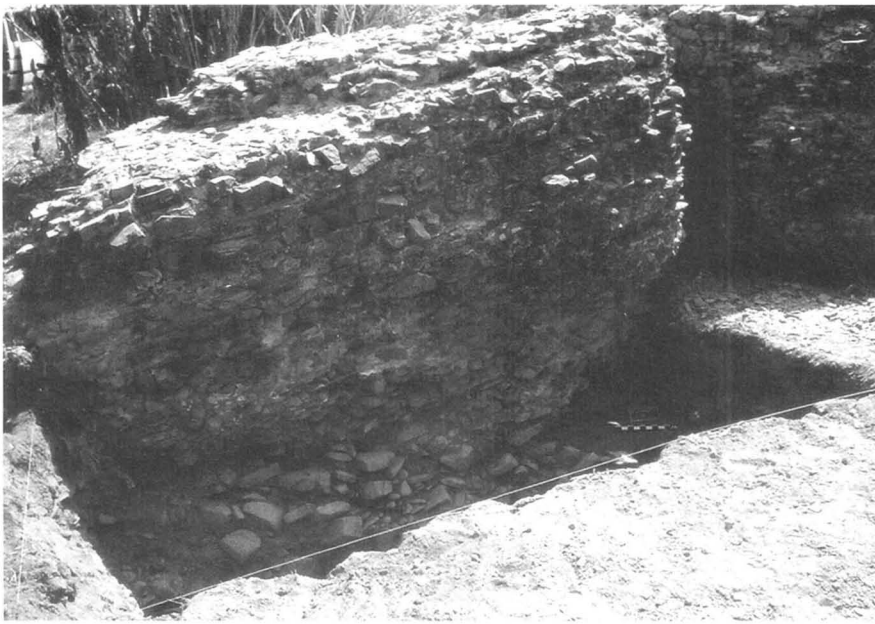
Barragem do Álamo. Vista do troço do paredão da barragem que basculou, provavelmente por sobre-excavação da fundação. Foto J. L. C.
